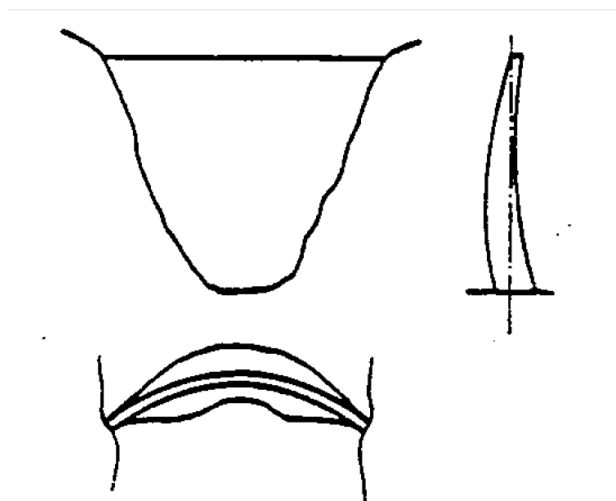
Planta, alçado e perfil transversal de barragens de betão do tipo abóbada. Adaptado de (Quintela 1990)
